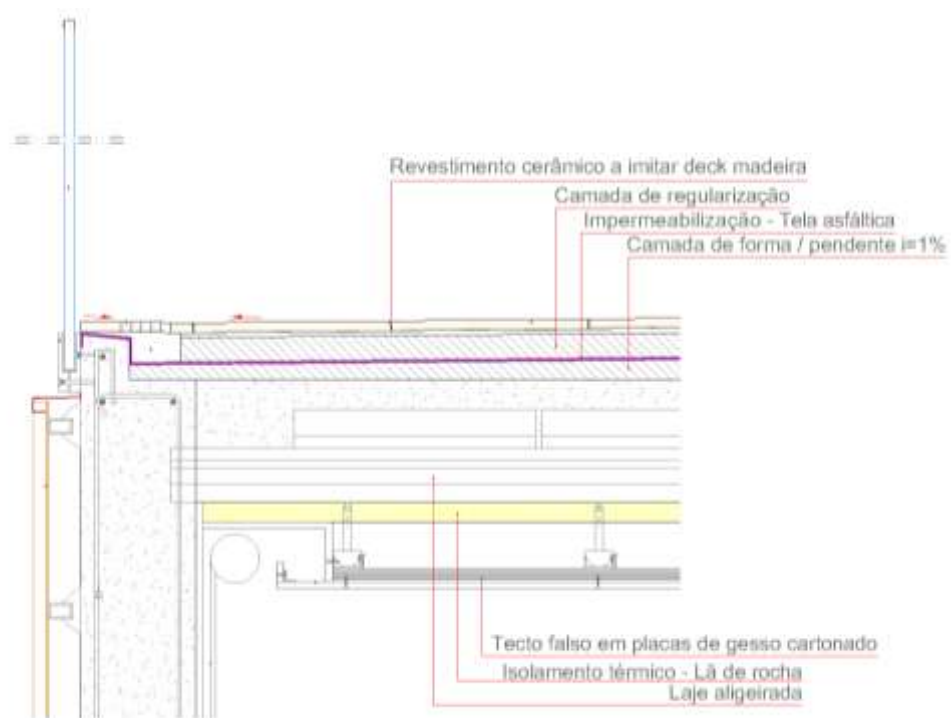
Pormenor construtivo da cobertura plana (P1)
